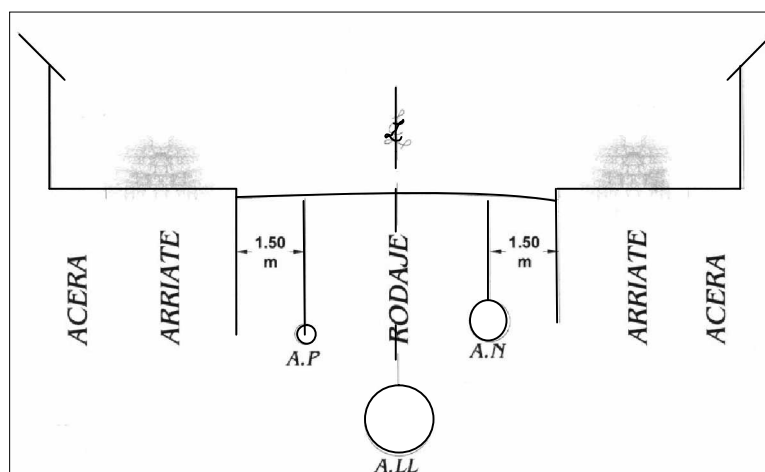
Detalle típico de ubicación de tuberías en un derecho de vía
